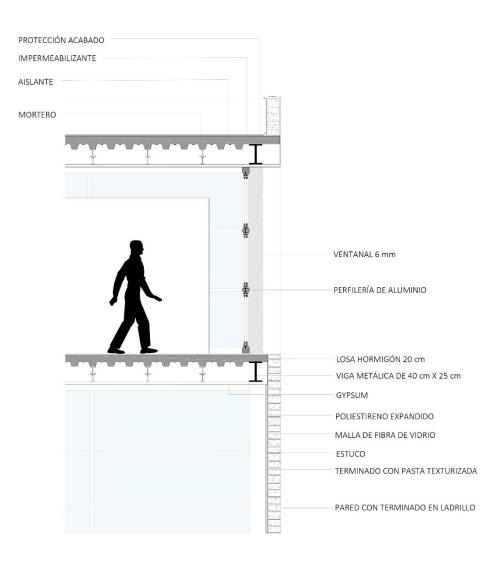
Detalle constructivo por fachada. Elaboración propia.
